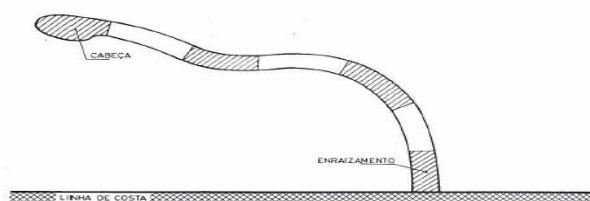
Disposição em planta de um Quebra-mar enraizado (Pita, 1985).
